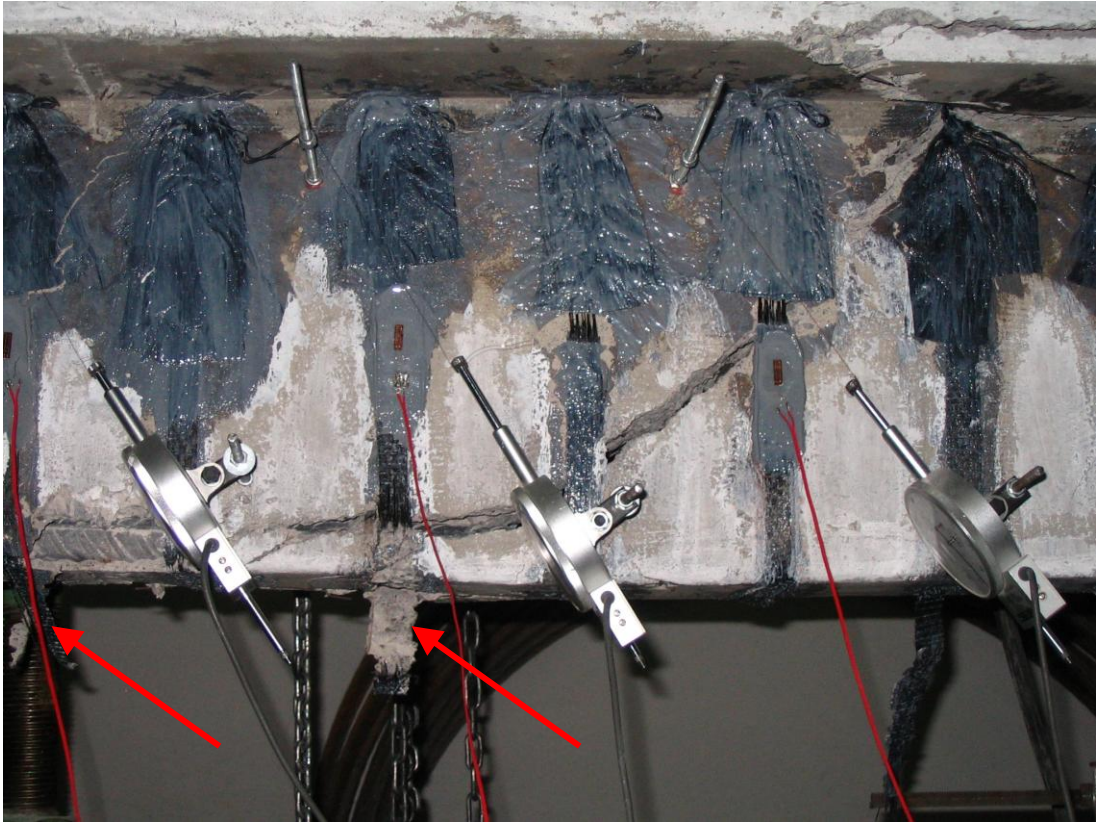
BHU numunesinde Hi-CFRP şeridin beton yüzeyden ayrılması (curling)
